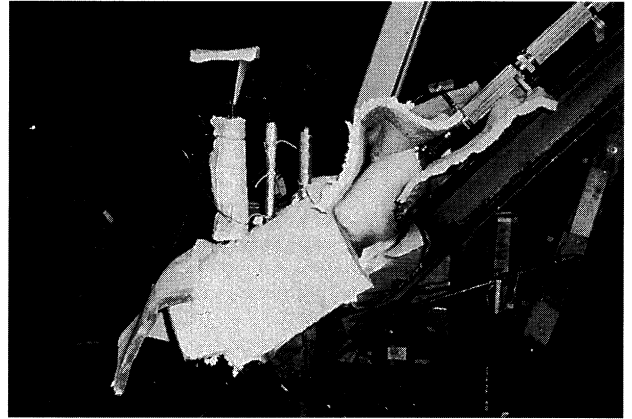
ウィリアムズバーグ橋 エポキシレジン注入
